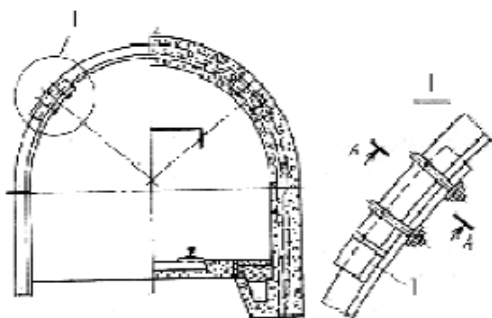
Металобетонне кріплення із спецпрофілю:
